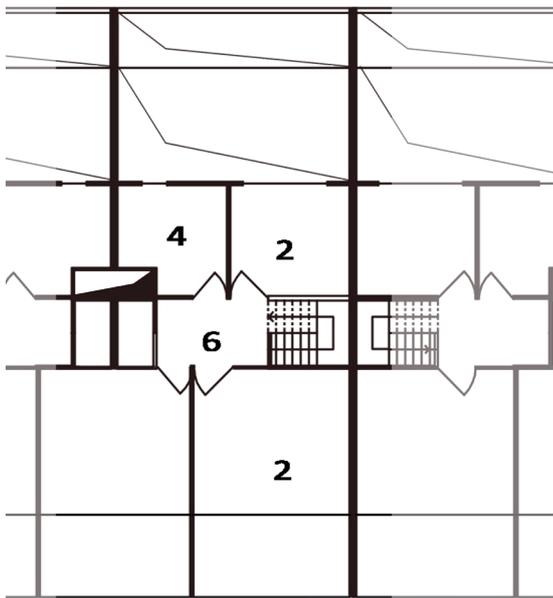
Die Villa- Wohnung- Grundriss & Bild M: 1/200
